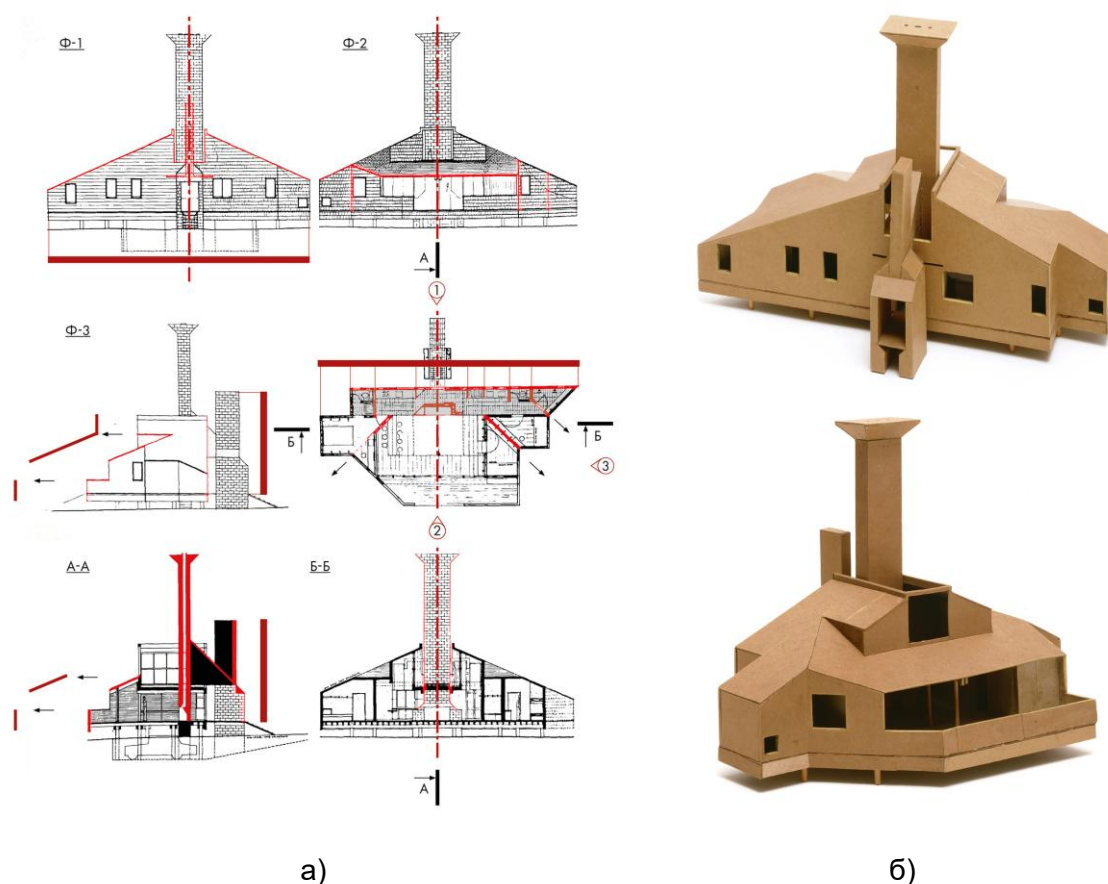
Дом на пляже, арх. Роберт Вентури: а) чертежи плана, фасадов и разрезов; б) макеты
